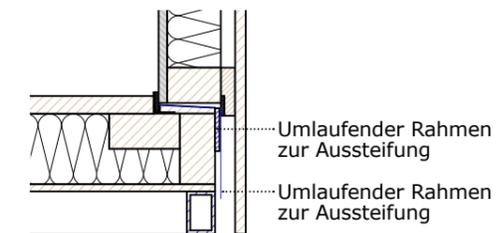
/2/3: Detailgrundriss Flügeltüre Rückseite
